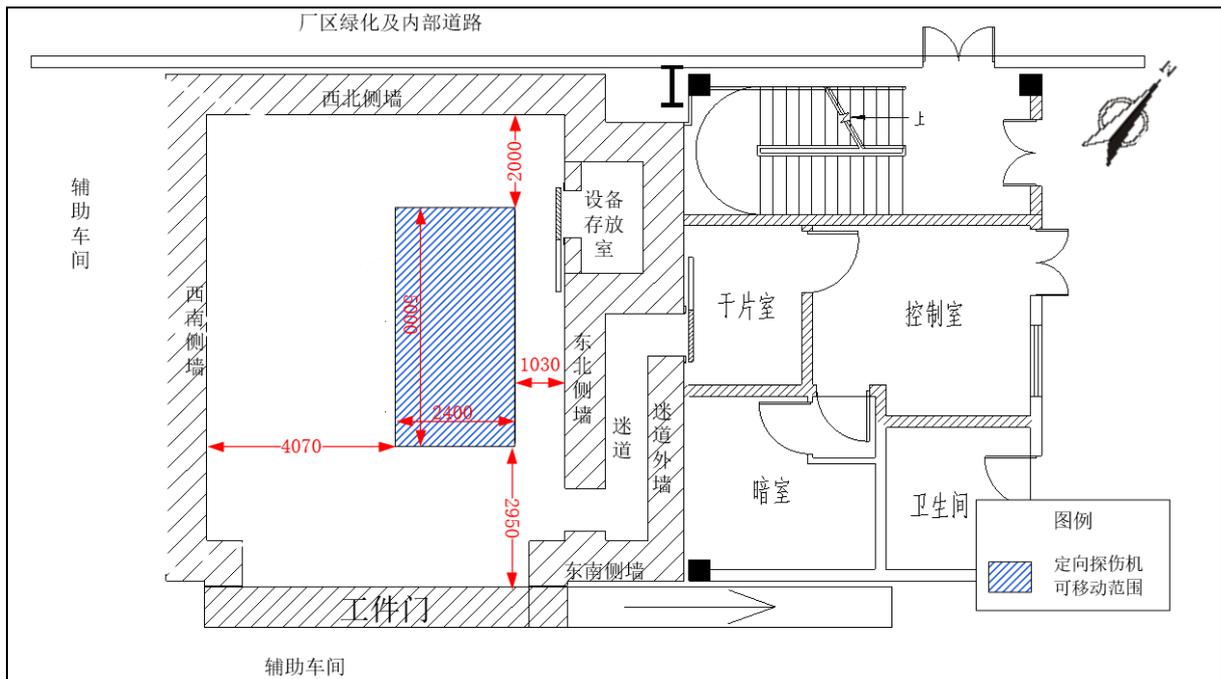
探伤室定向探伤机可移动范围示意图（平面图）
